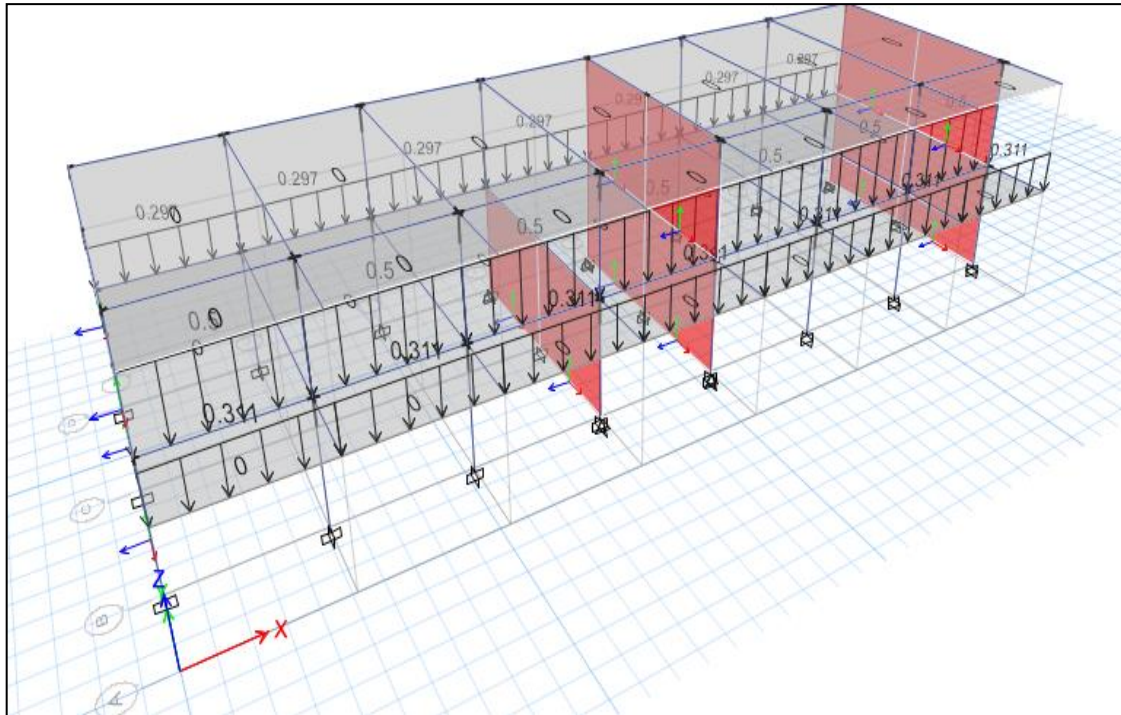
Cargas distribuidas de parapetos y tabiquería en eje B y D del pabellón 3
